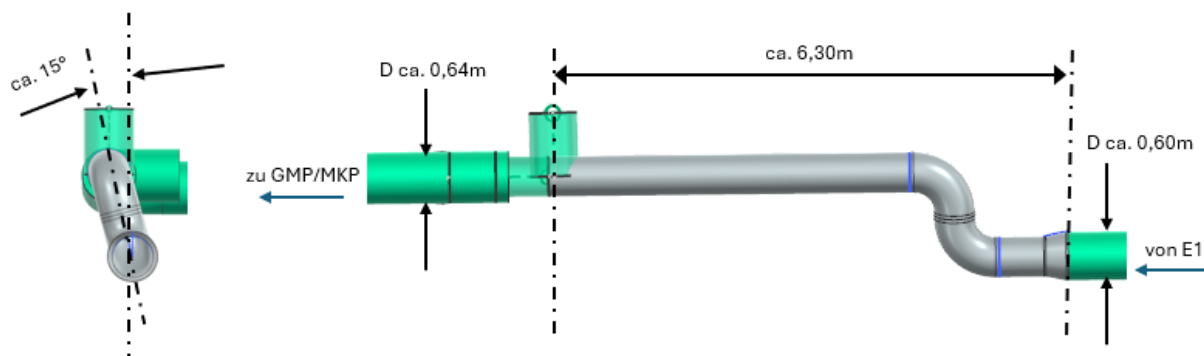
Übersicht Umschluss Abgasführung Plan Zielzustand
